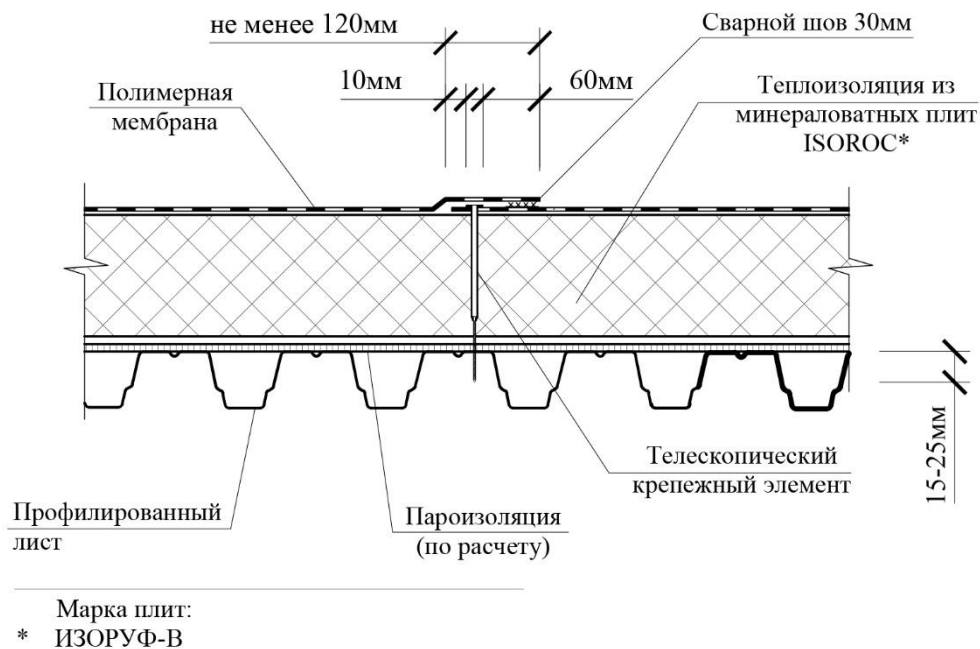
Устройство гидроизоляционного кровельного ковра из ПФХ-покрытия.
